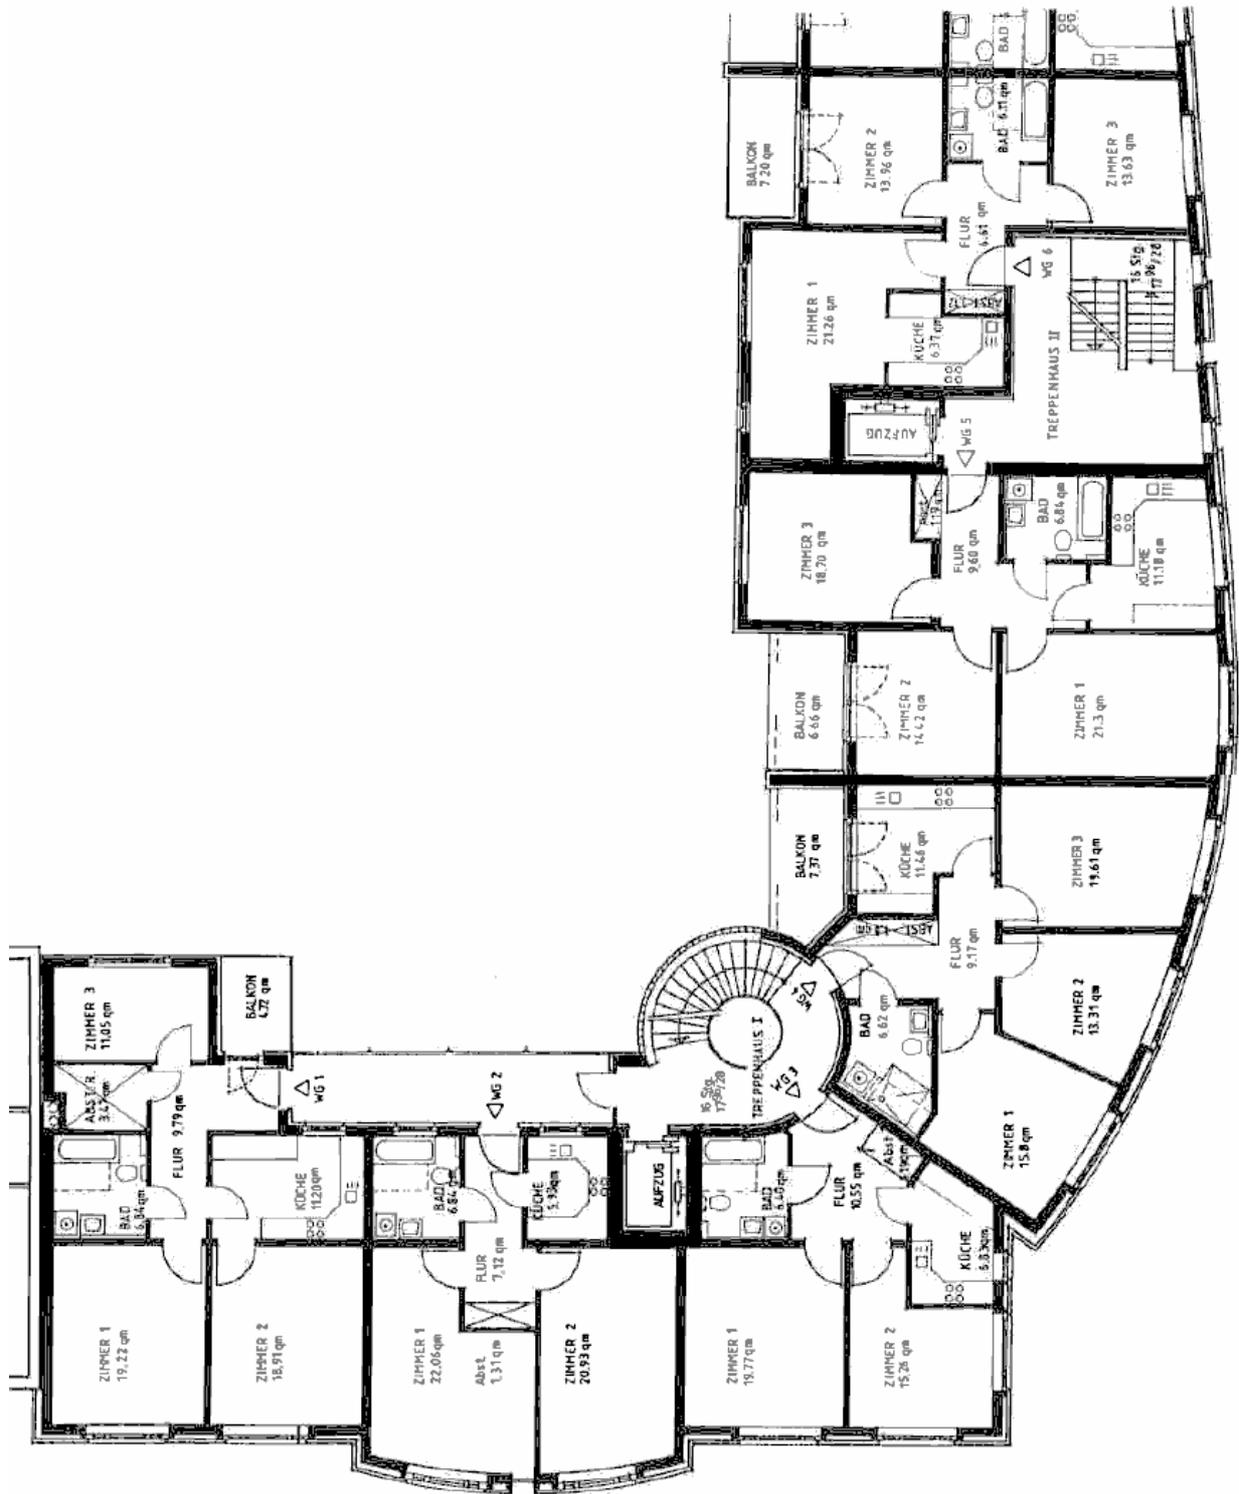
Grundriss der Wohnanlage in Hamburg-Wandsbeck
